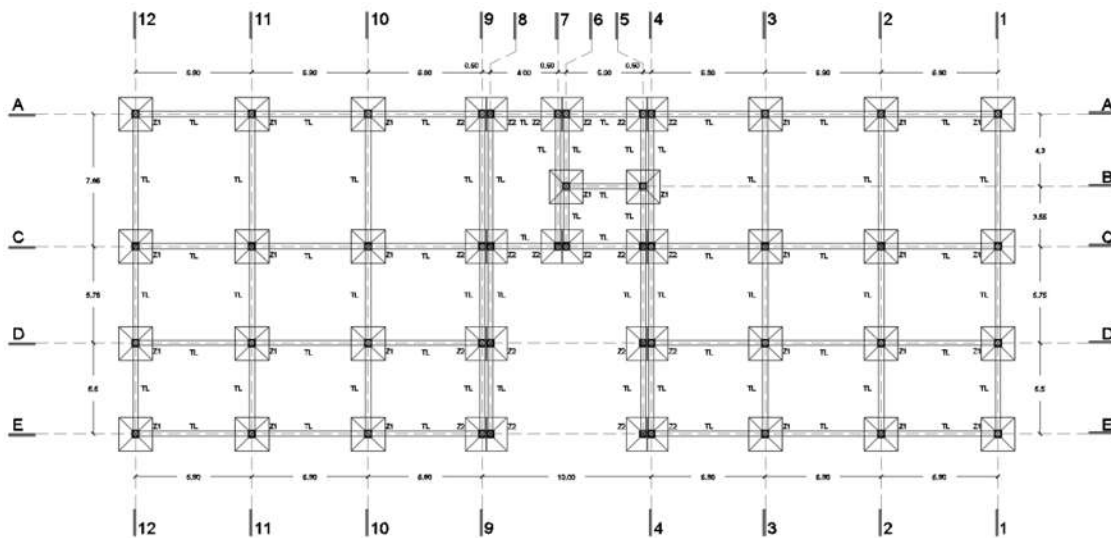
Dibujo de zapata aislada dentro del proyecto. Fuente: autor
